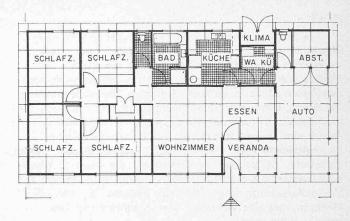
Grundriss der 5½-Zimmer-Einfamilienhäuser
